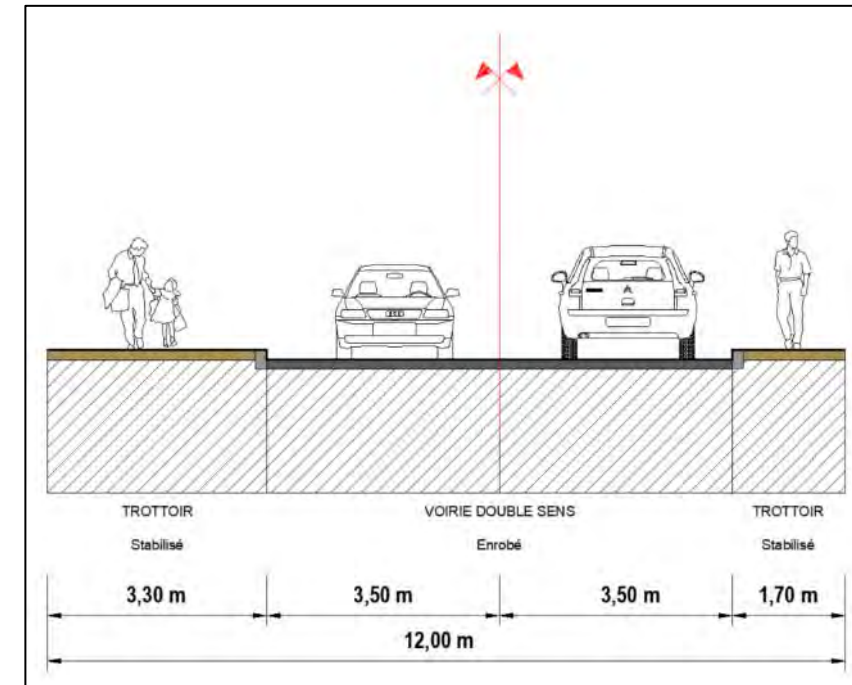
Profil en travers type existant entre la rue de la Princesse et la rue des Sources du Peugeot
